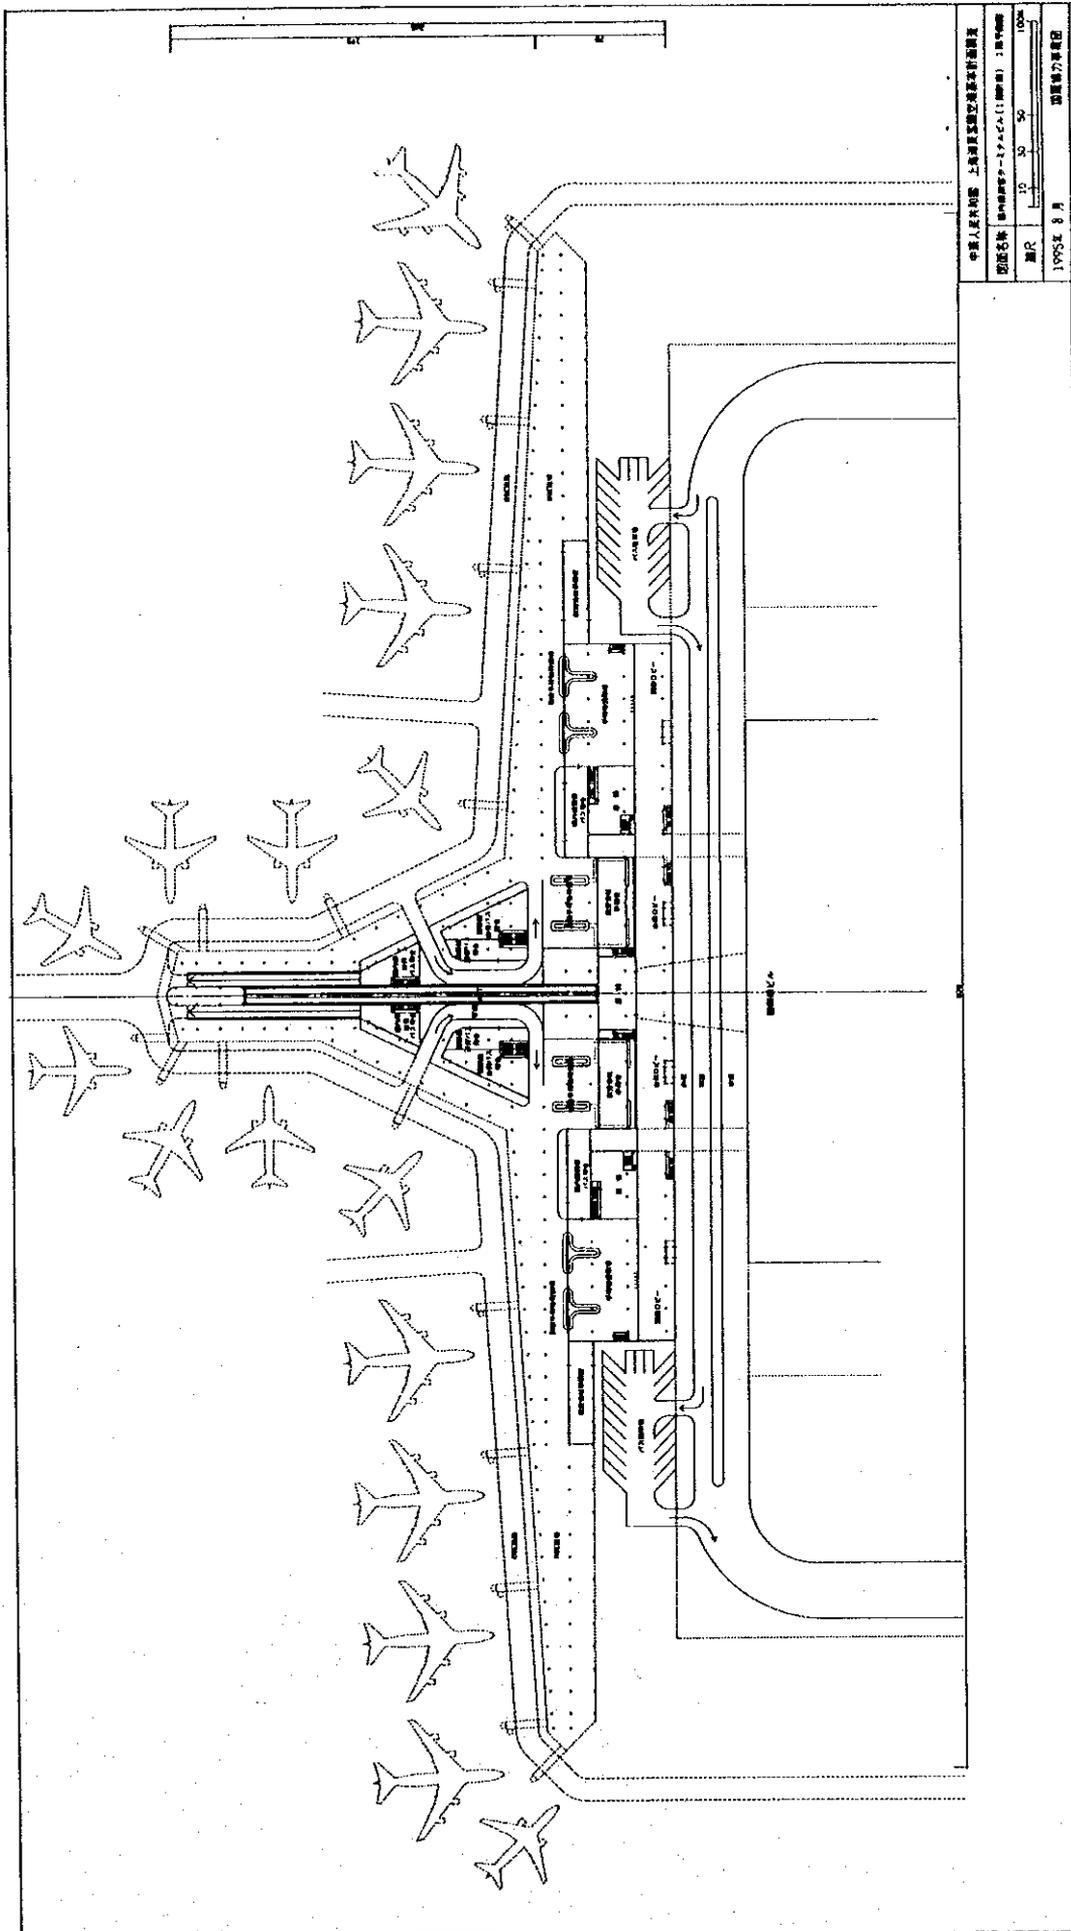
国内线旅客航站楼ビル (1期計画) 1階平面図
